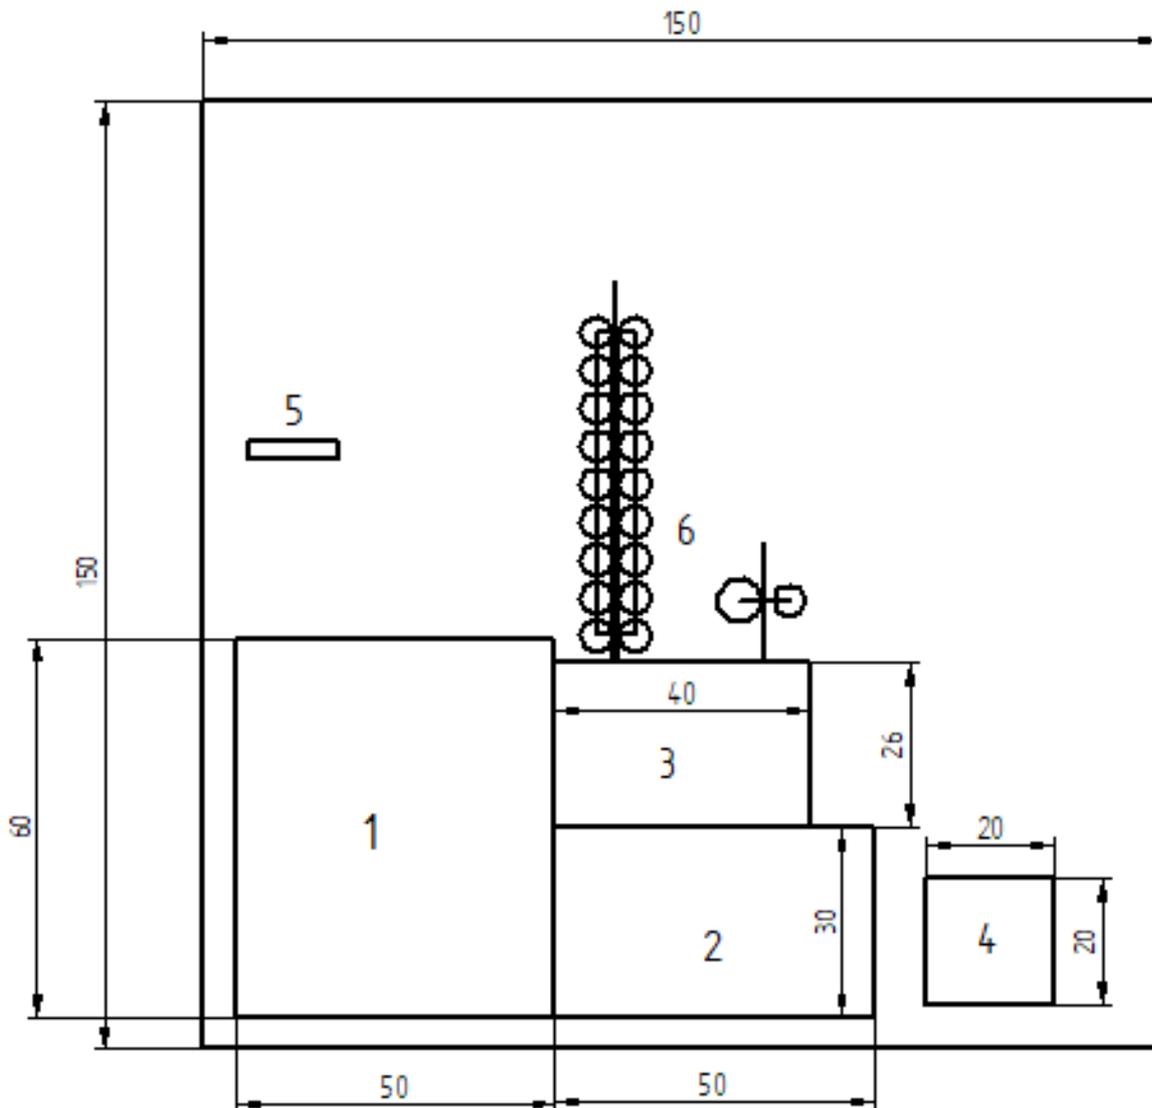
Plano general de la planta. Medidas en metros. Leyenda en Tabla 7
